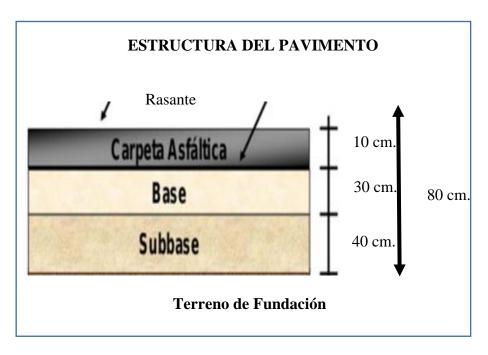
Estructura del pavimento, según mepdg. Aashto 2008
